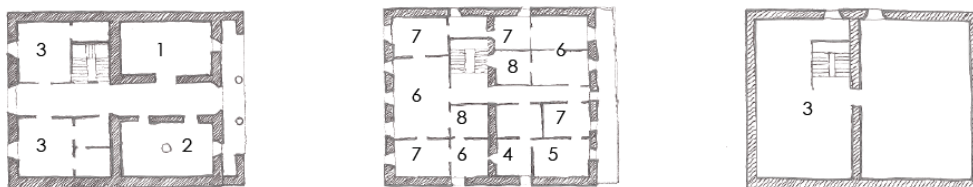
Planta baja, planta alta y planta bajo cubierta del caso de estudio 1 – Tipología 3
